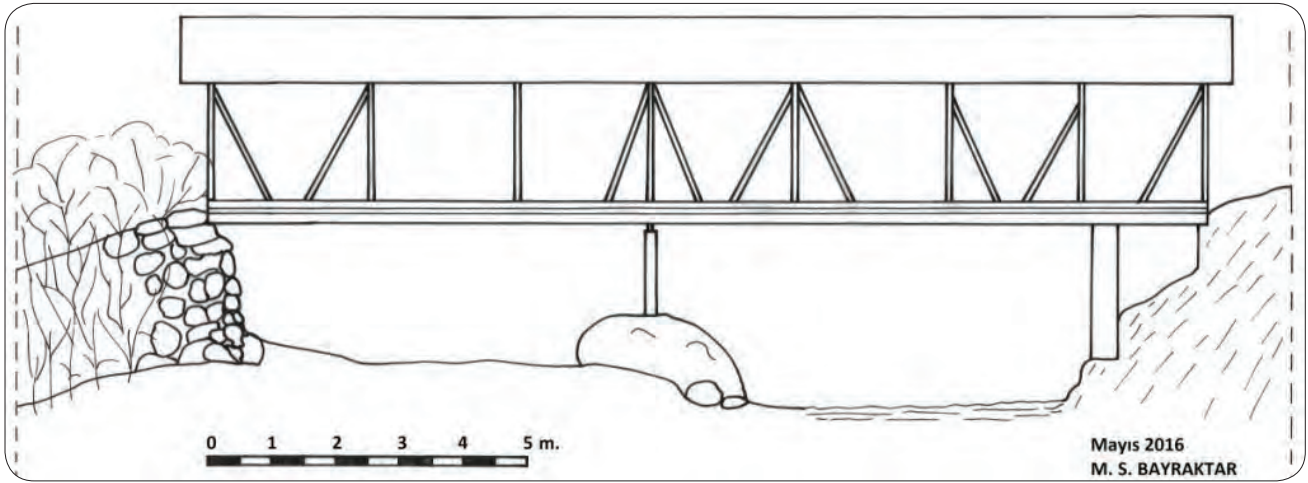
Giresun Lapa Köyü Ahmet Ağa Köprüsü menba (doğu) cephe / Ahmet Ağa Bridge upstream (east) side at Lapa Village in Giresun
